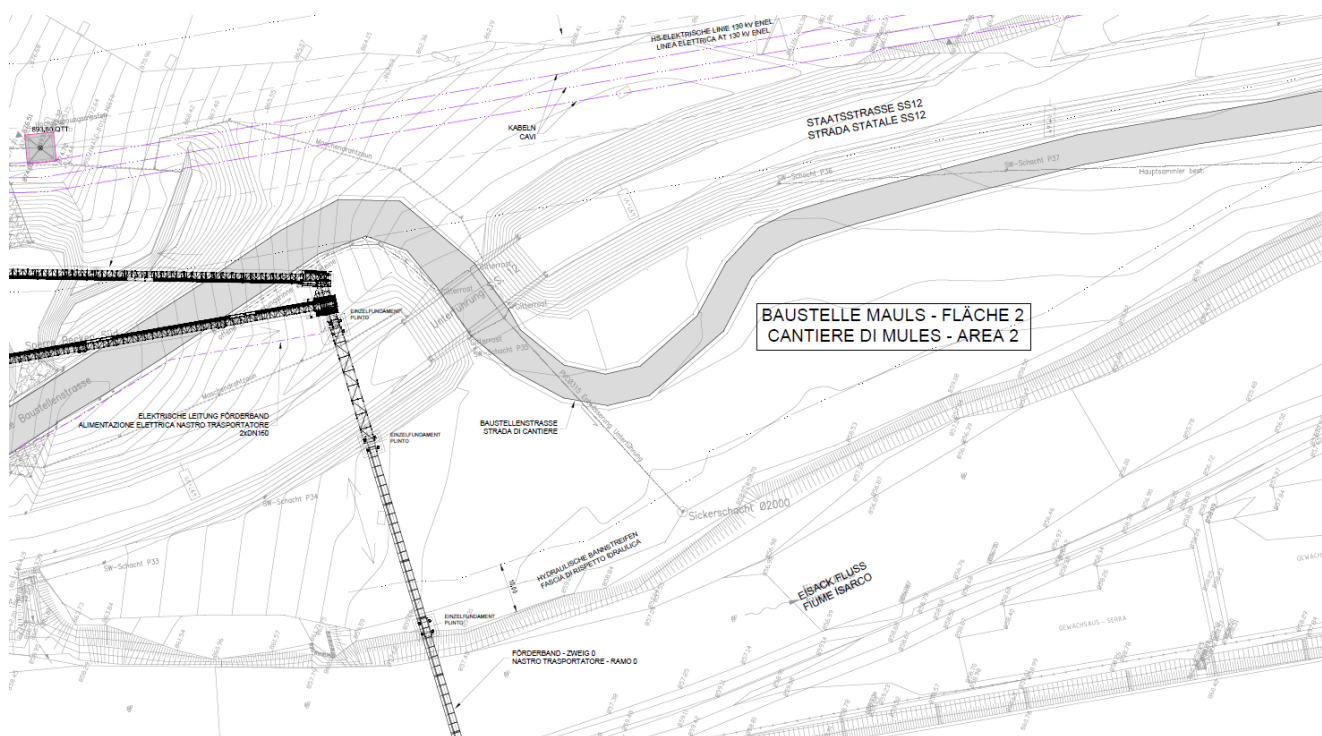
Baustelle Mauls: Lageplan Fläche Nr. 2
